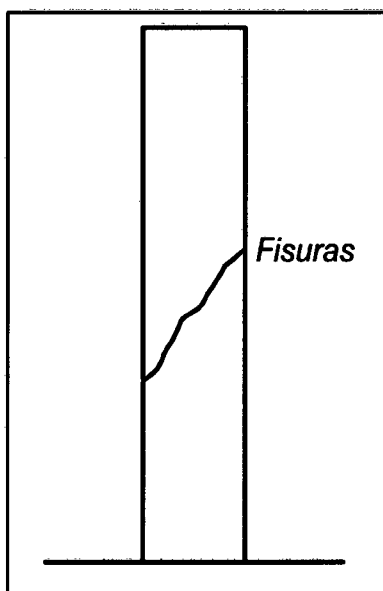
Fisuración inclinada en columnas por cortante (Pérez, 2008).
